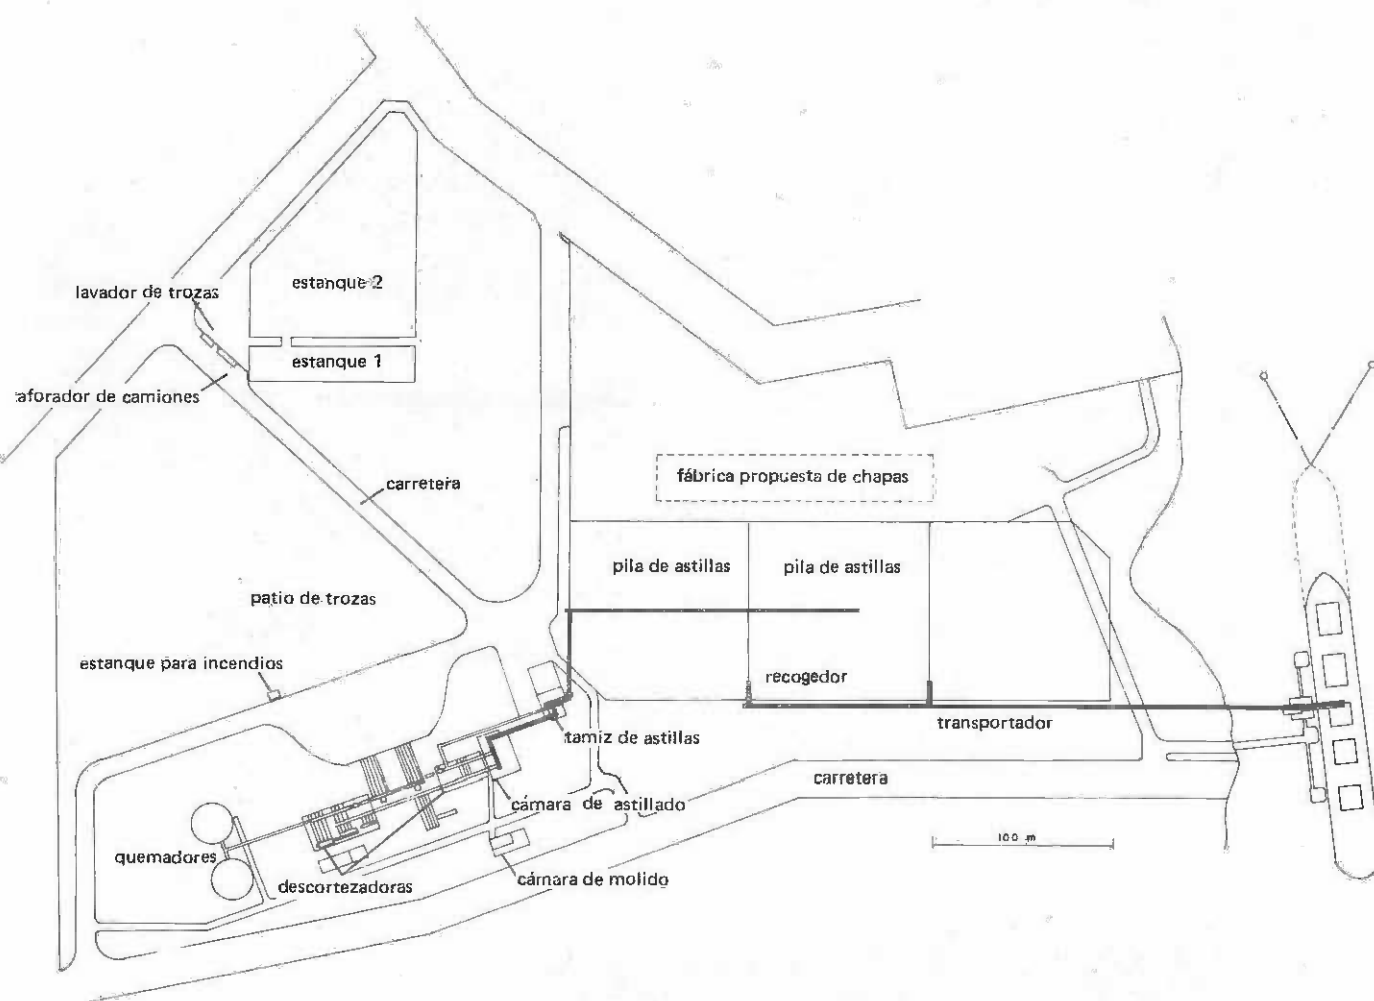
Planta de la industria de astillas de maderas frondosas tropicales mezcladas de Jant Pty Ltd. en Papua Nueva Guinea.
